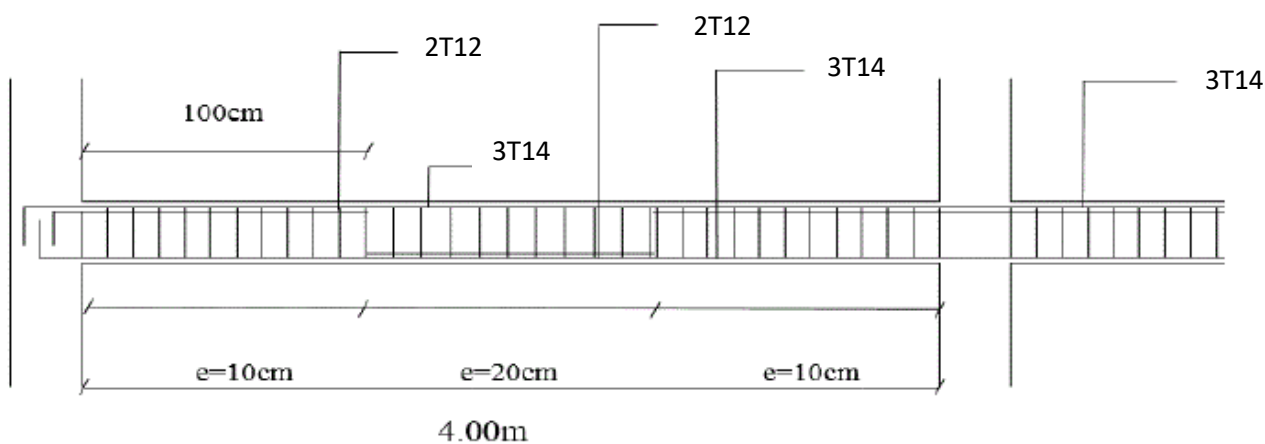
Dispositions typiques des chainages en plan (poutre Non Porteuses du RDC).
